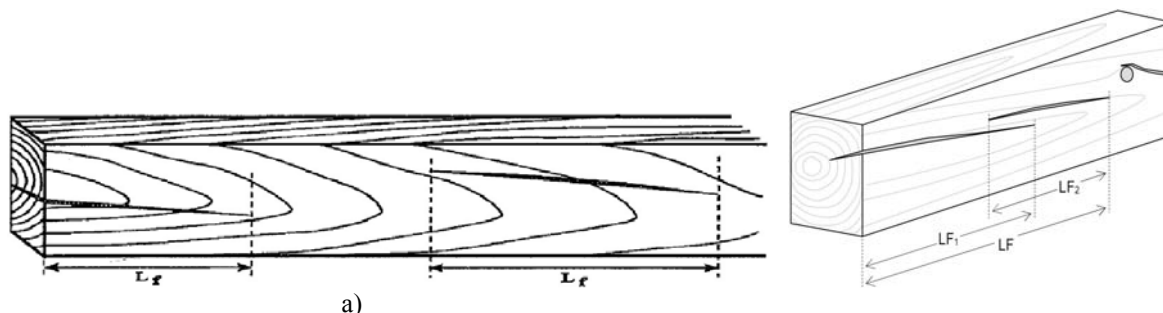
Medição de comprimento de fenda (L_f): a) Fontes: CRUZ et al (1997) Apud FRANCO (2008); SANTOS (2009a); b) HERRERO (2003).
